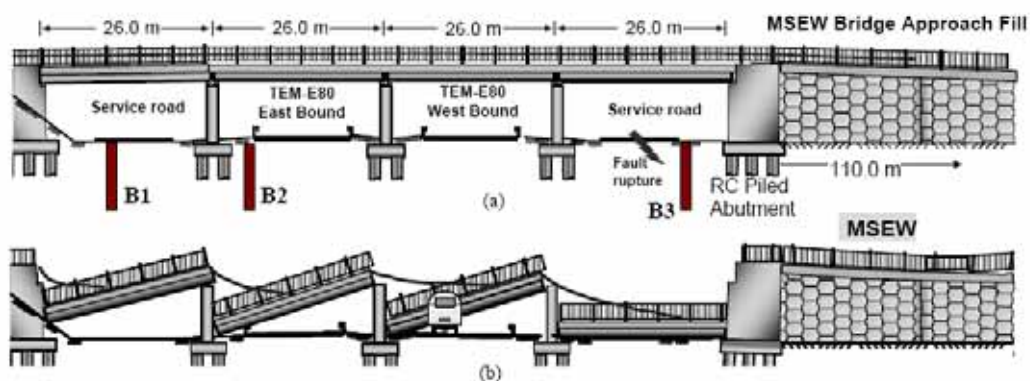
L'effondrement du pont de l'autoroute (TEM)
